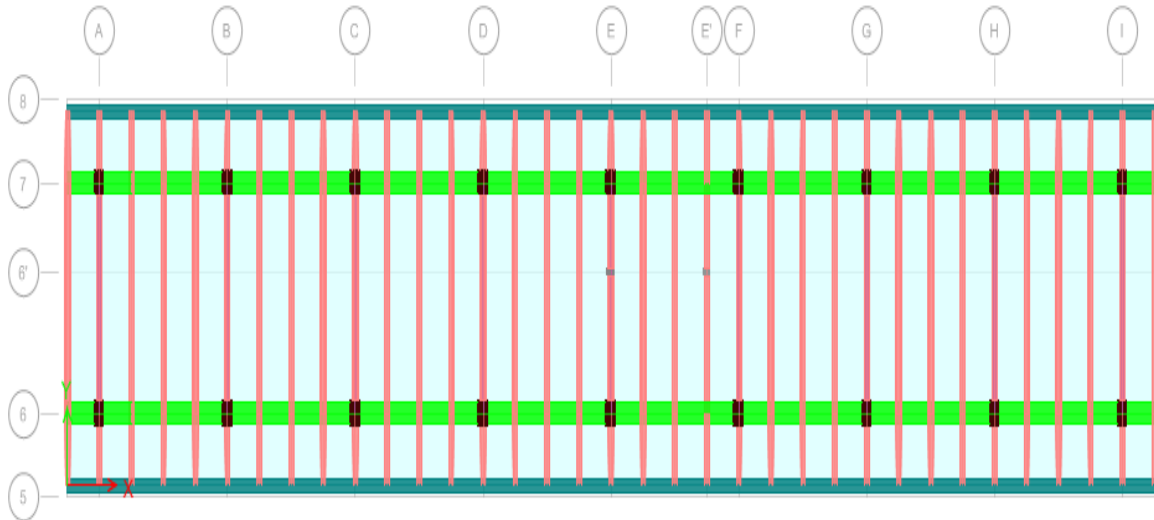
Planta estructural Estructura 4.1 Torre Oriental
